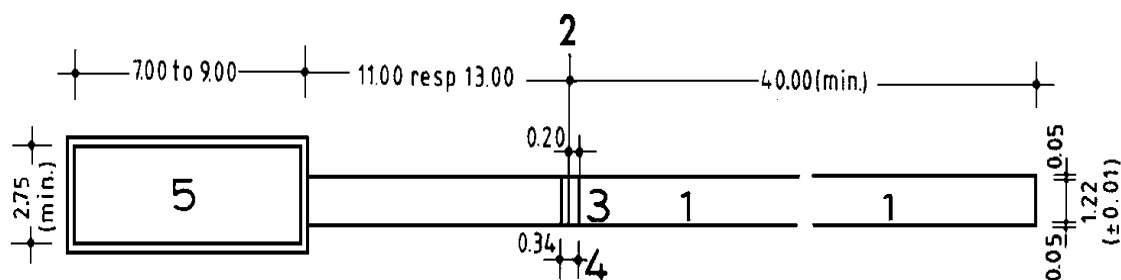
Instalación para el triple salto (Dimensiones en m.)
